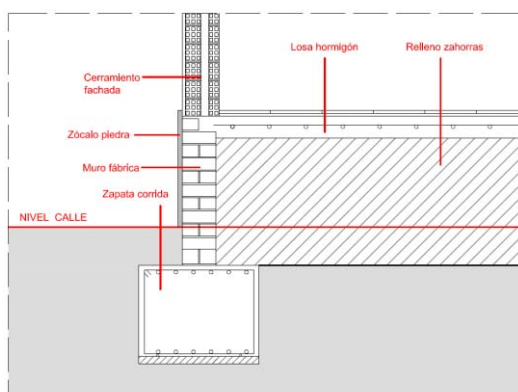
Detalle cimentación [Anexo II. Planos]
